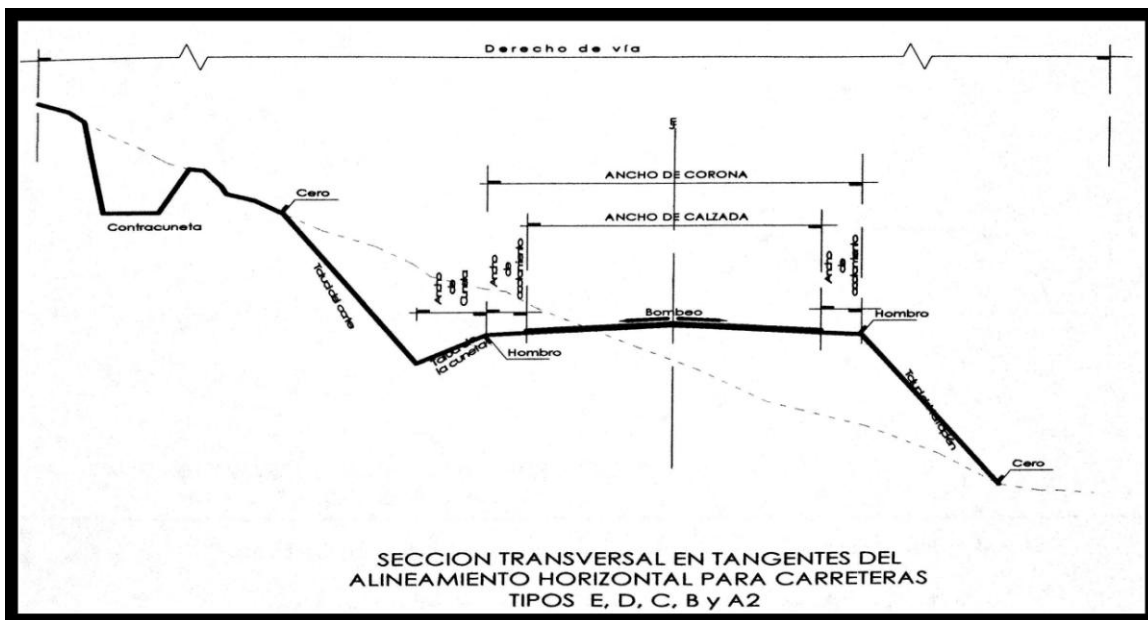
Sección transversal en tangente del alineamiento horizontal para carreteras tipo E, D, C, B, y A2.
